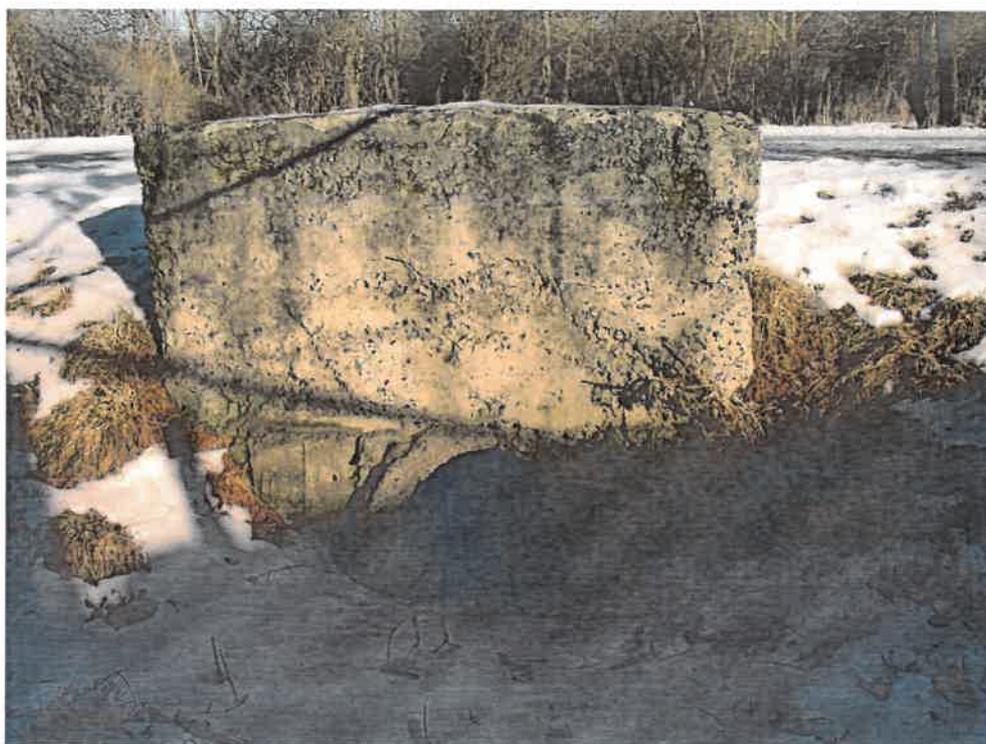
Общий вид входного оголовка. В зоне оголовка трубы растёт трава, наносы грунта, отсутствует укрепление. Бетон портальной стенки (монолитного кордона) разрушается от размораживания и солнечной радиации, гидроизоляция не устраивалась.
